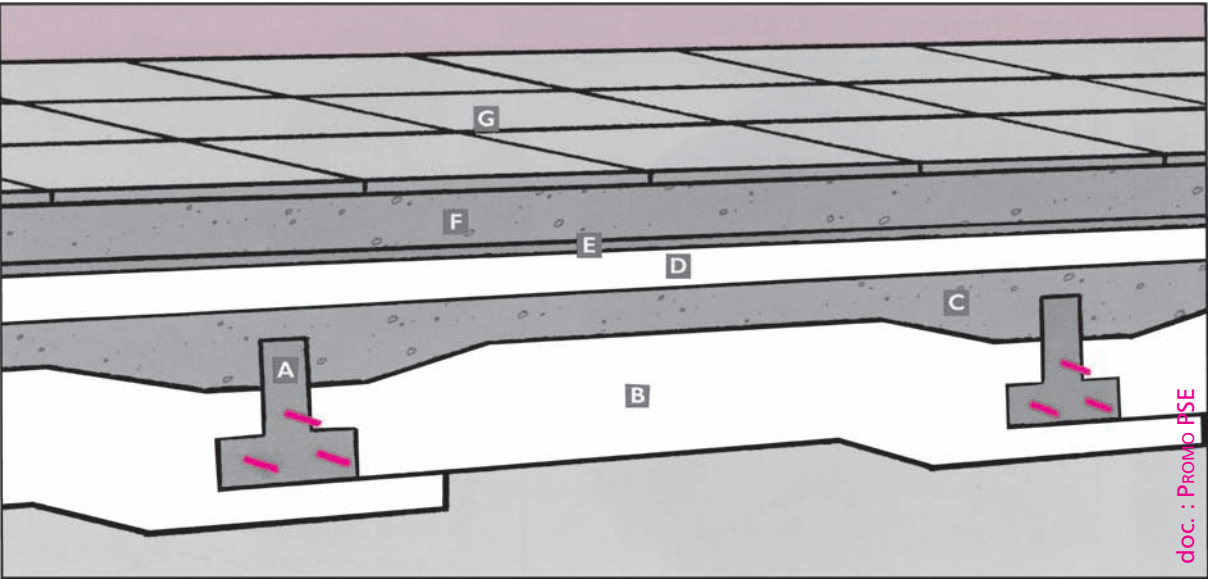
Plancher sur vide sanitaire avec dalle flottante sur isolant
